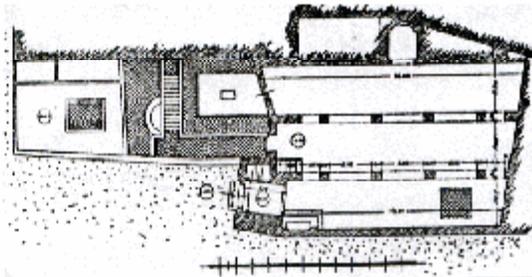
مسقط أفقي لمسجد جزام بن عمرو بفاس القديمة
